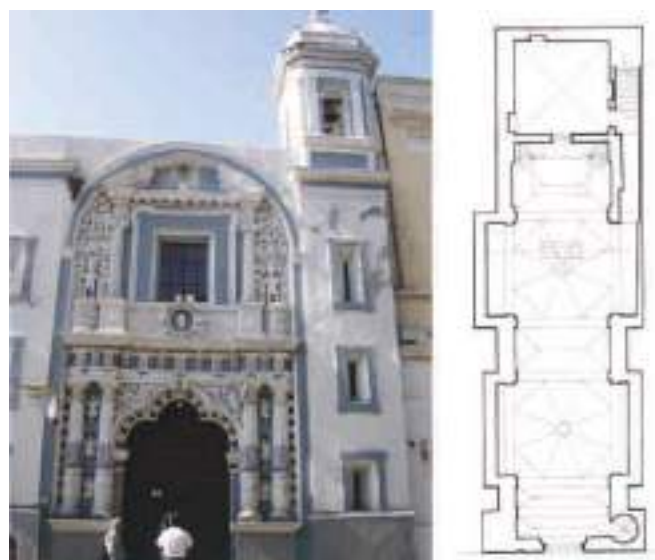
Fachada y Planta arquitectónica de la Capilla de Dolores, Ciudad de Puebla.
